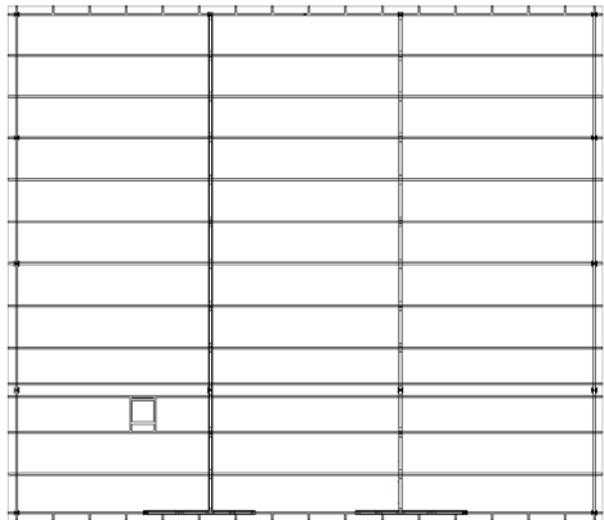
Esquema de distribución de viguetas de Planta Primera. (Elaboración propia, Allplan).
